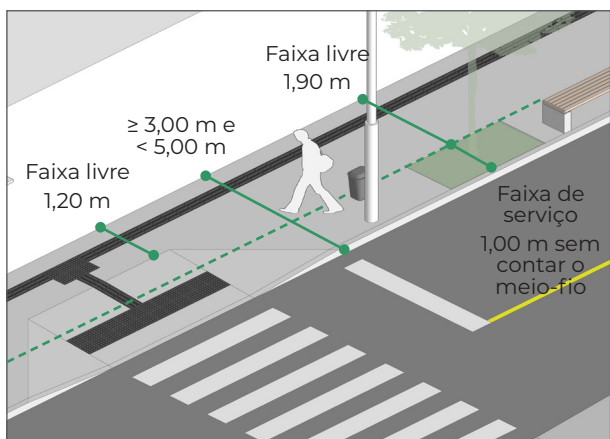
Faixa livre e faixa de serviço em calçadas com largura igual ou superior a 3,00 m e inferior a 5,00 m.
